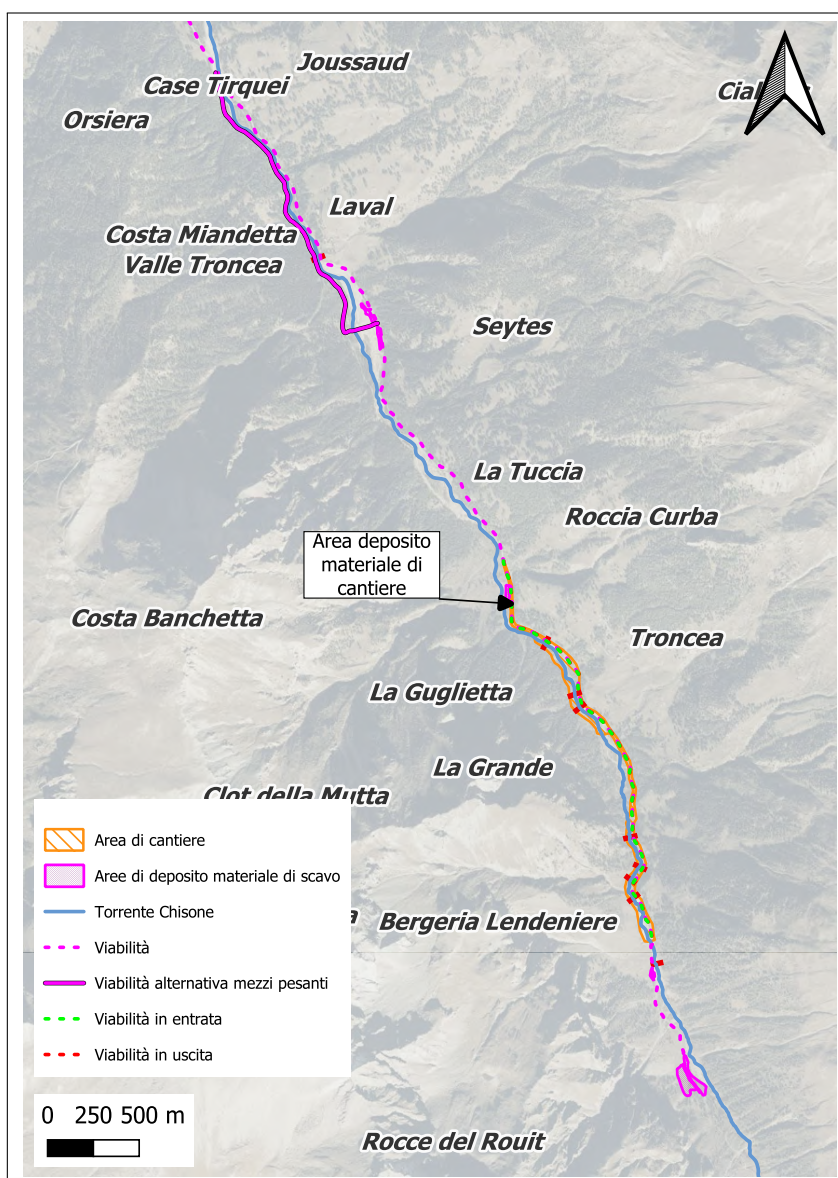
Viabilità di accesso al cantiere, zona di monte
